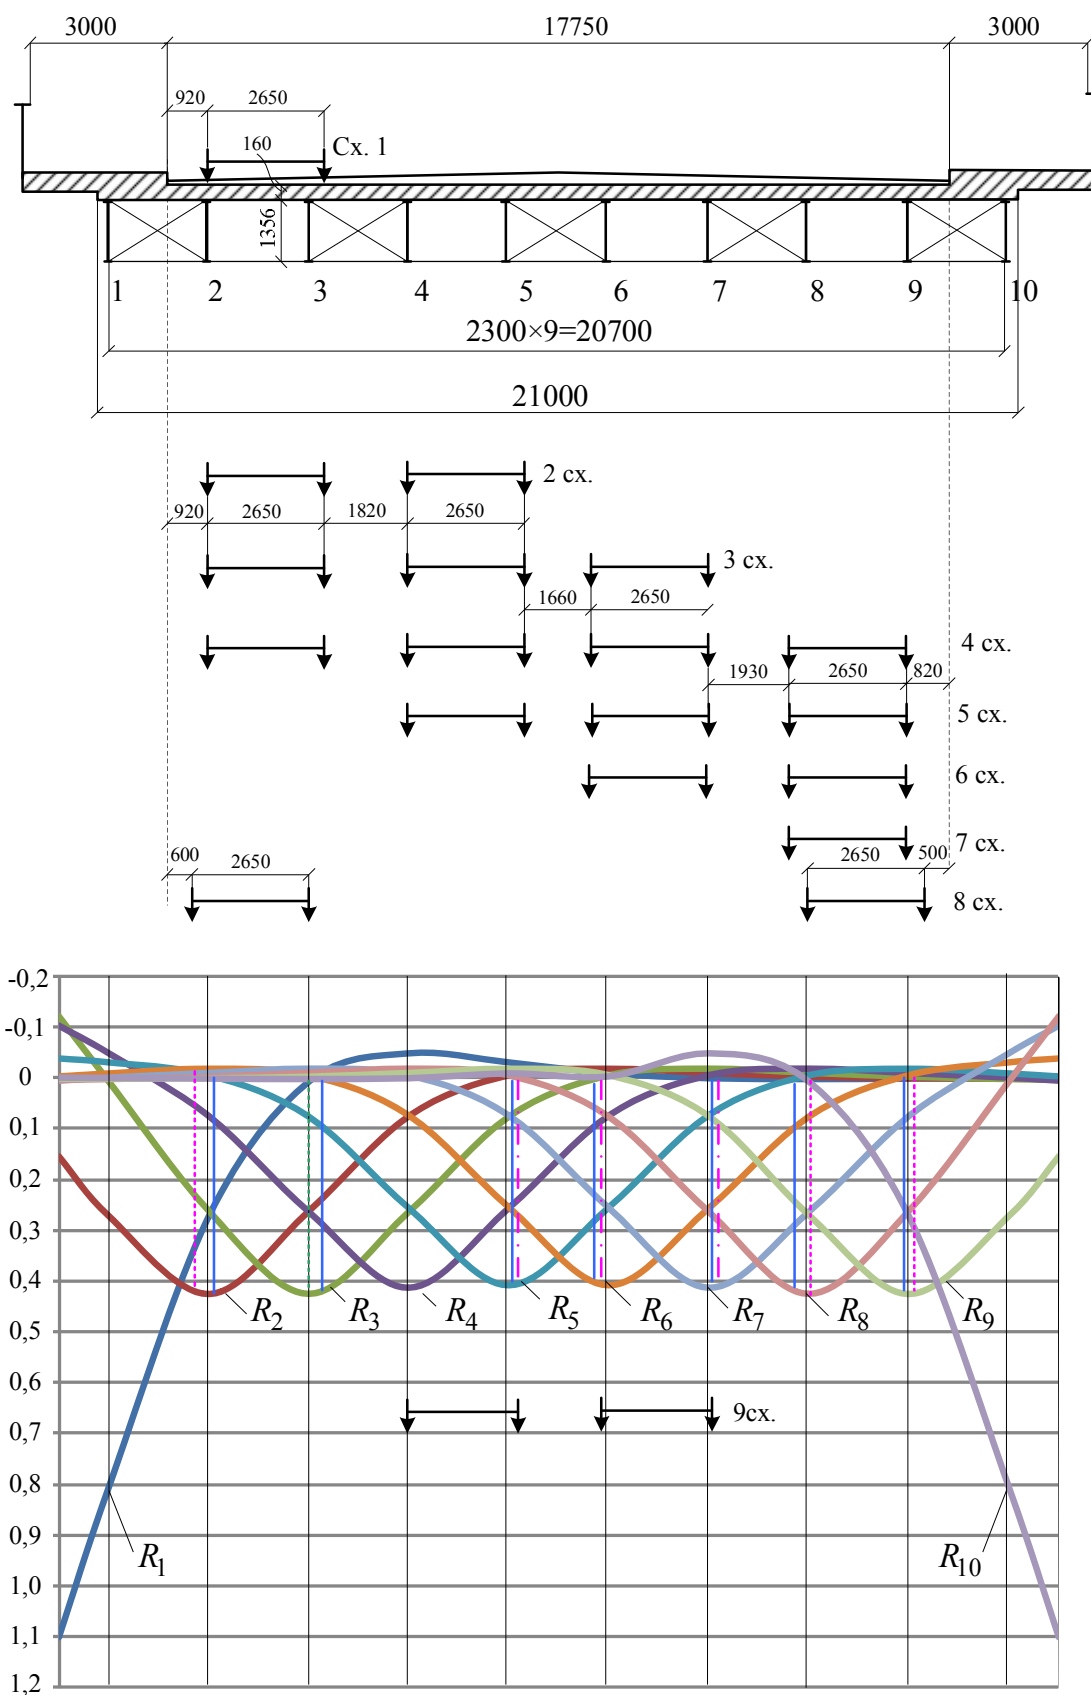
Линии влияния сил, передаваемых плитой на металлические балки, и схемы их загрузки испытательной нагрузкой
